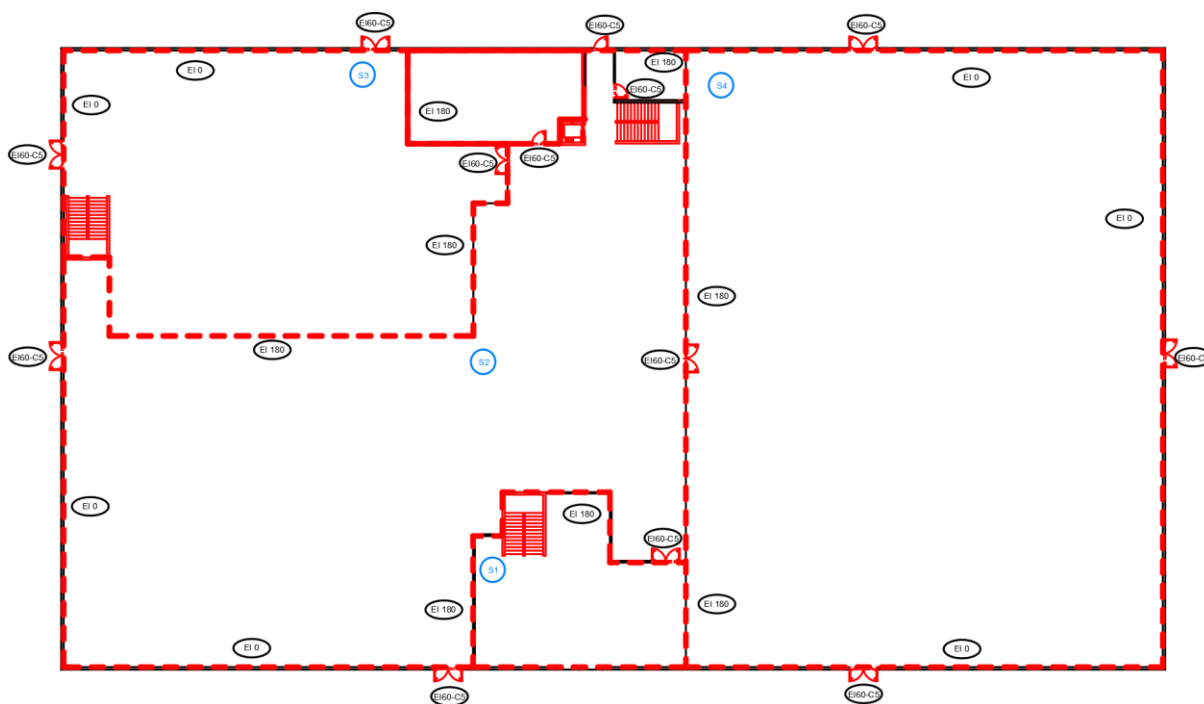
Resistencia al fuego de los cerramientos de proyecto para la planta baja.
